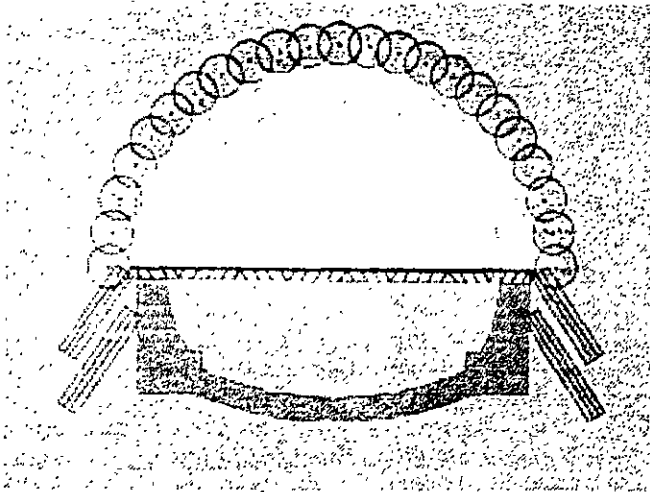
ESTABILIZACIÓN PERIMETRAL CON LA TÉCNICA DEL JET GROUTING
